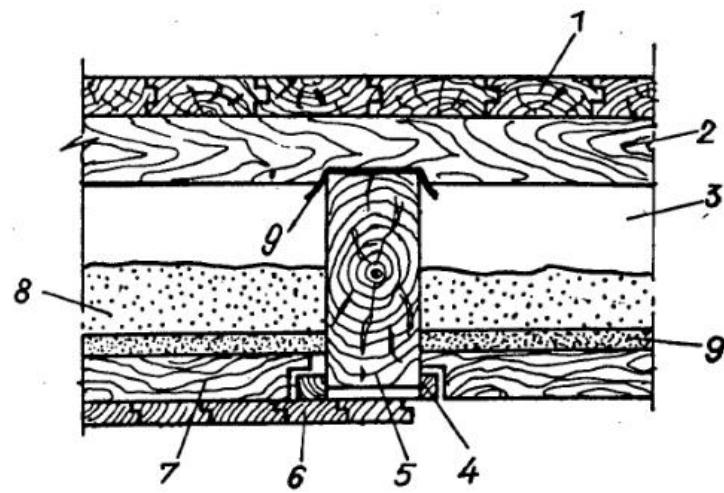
Конструкция междуетажного перекрытия по деревянным балкам: 1 — пол; 2 — лага; 3 — воздушная прослойка; 4 — череной брусков; 5 — балка; 6 — подшивка; 7 — накат; 8 — засыпка или утеплитель; 9 — гидроизоляция.
